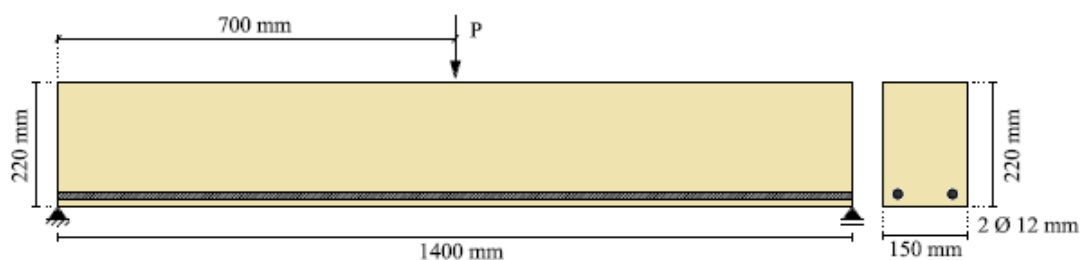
Viga de concreto armado estudada por Mazars e Pijaudier-Cabot (1989).
